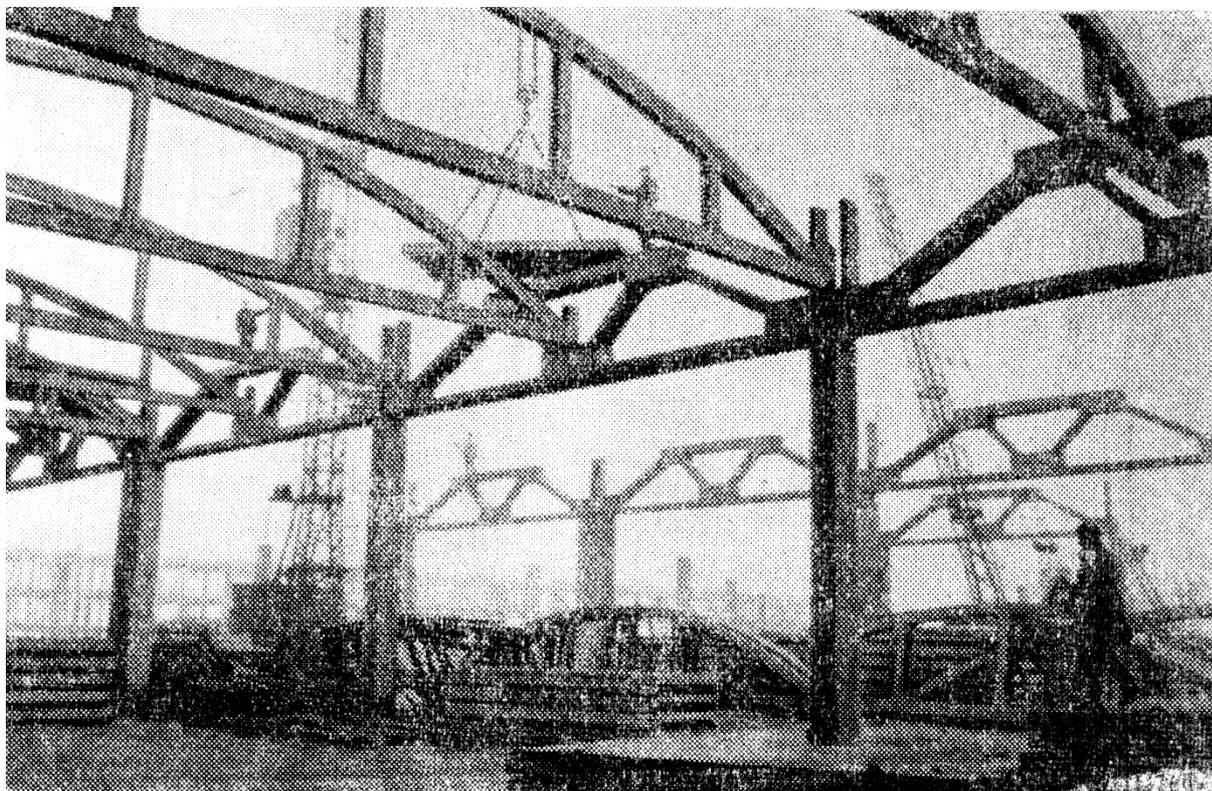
Монтаж конструкций одноэтажного промышленного здания
